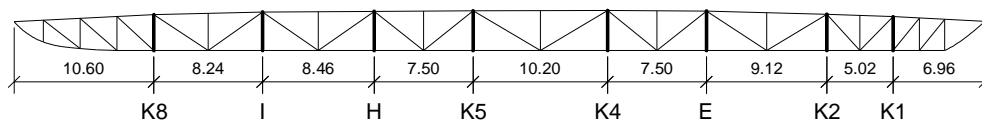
Rzut z góry na konstrukcję dachu wg pierwotnego projektu
